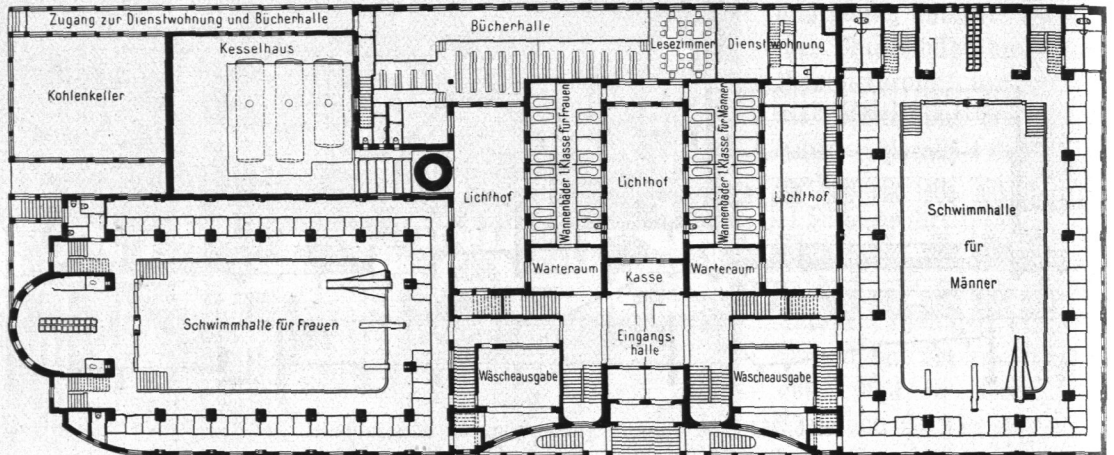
Badeanstalt Hammerbrook, Erdgeschloß, Grundriß.
